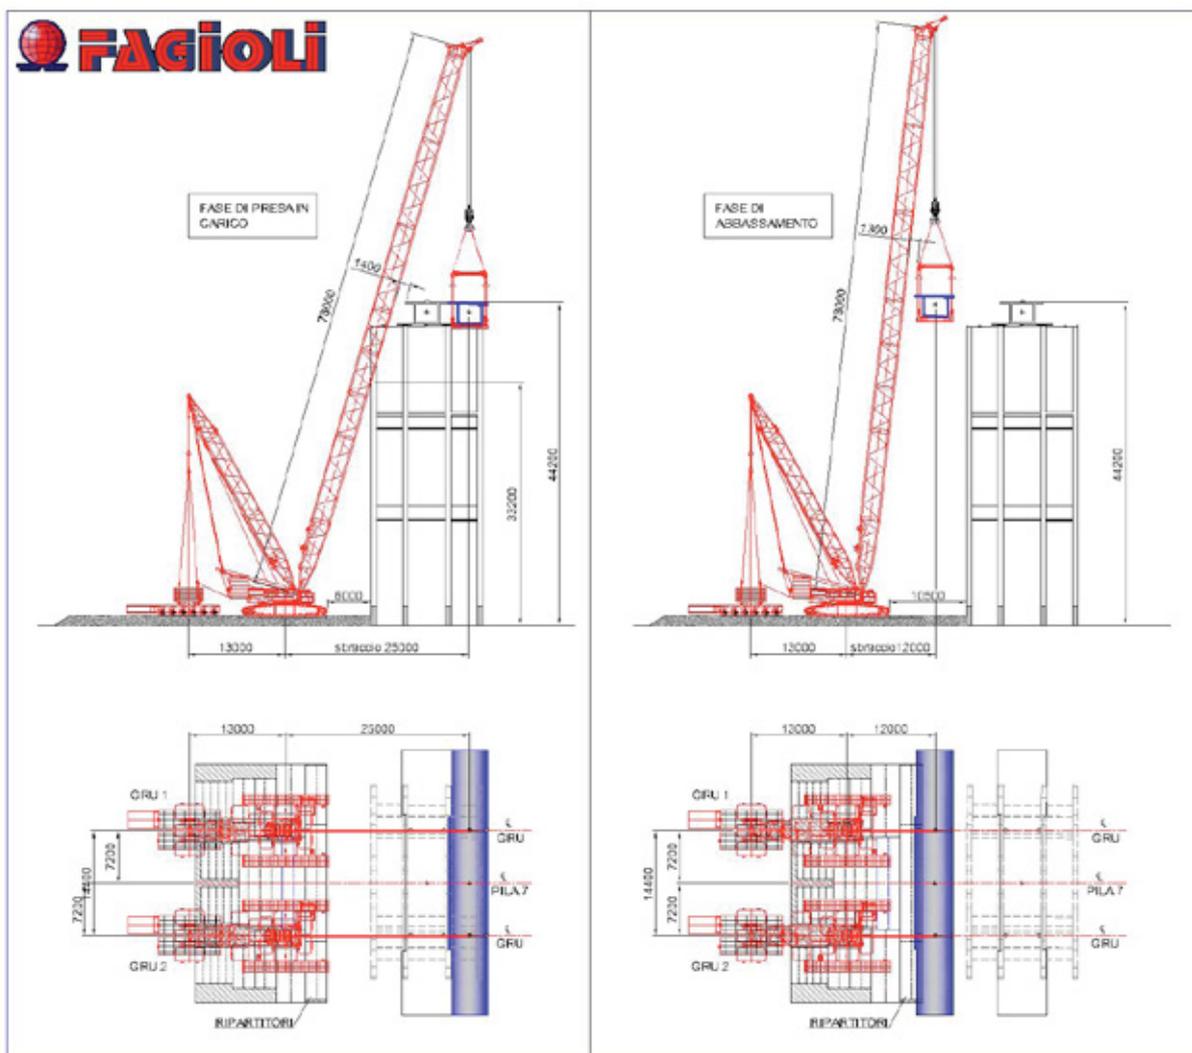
Smontaggio di un concio di pila con gru CC2800 – elaborato grafico
